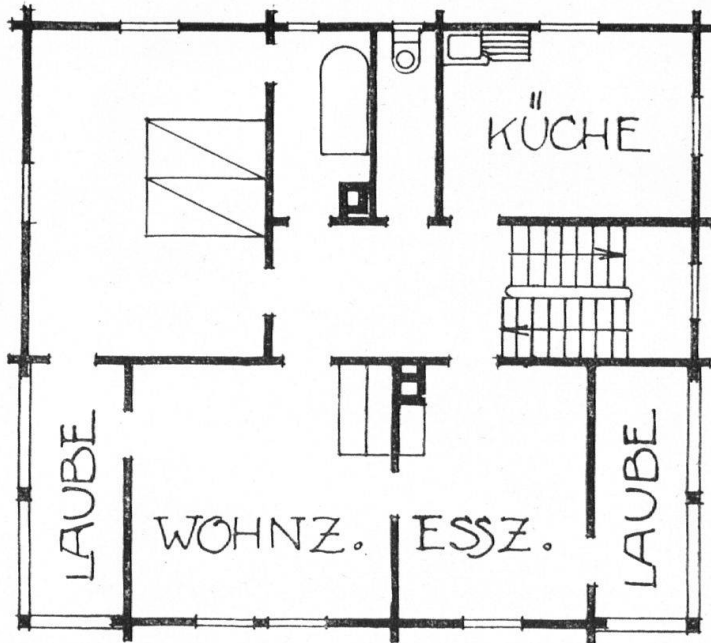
Grundriss Chalét Flückiger, Interlaken (siehe Abb. 10).
